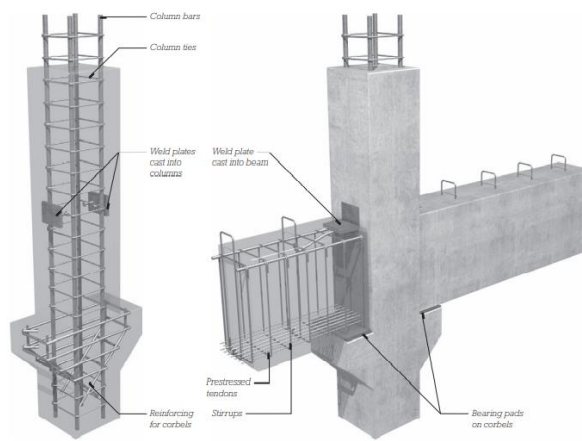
assemblage poteau -poutre préfabriqué (source : ouvrage<sup>8</sup>)
